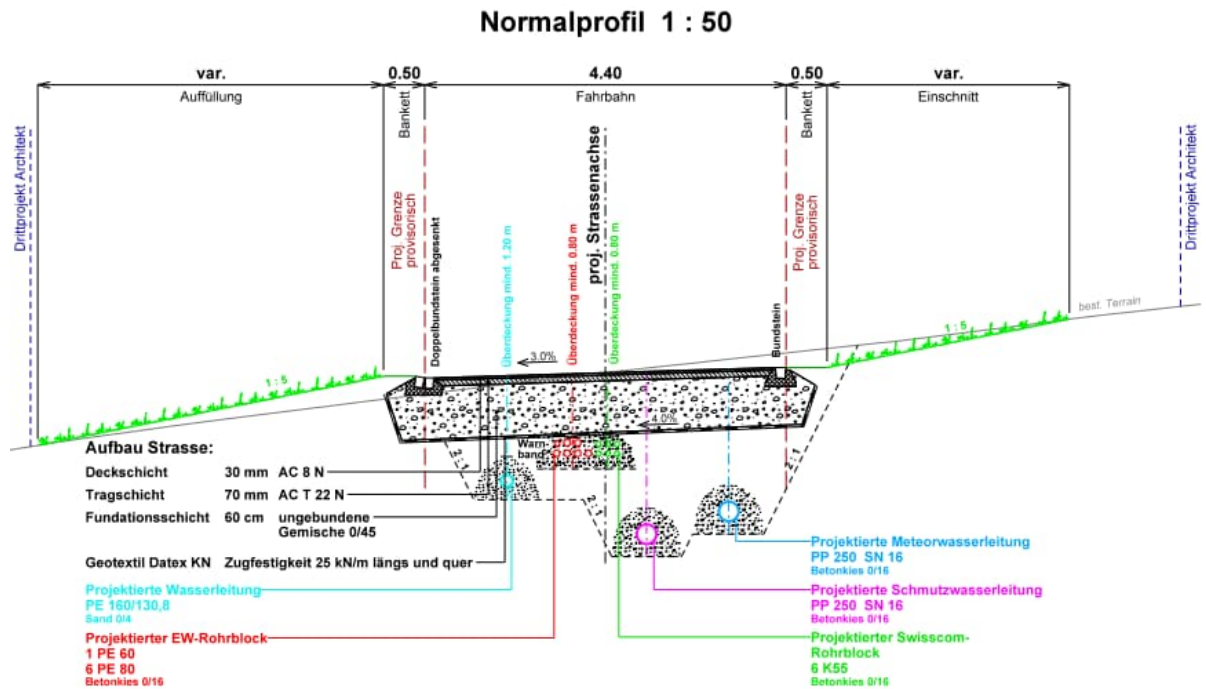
Ausschnitt Normalprofil Strasse und Werkleitungen, Plan Nr. 1331 03.06-1
